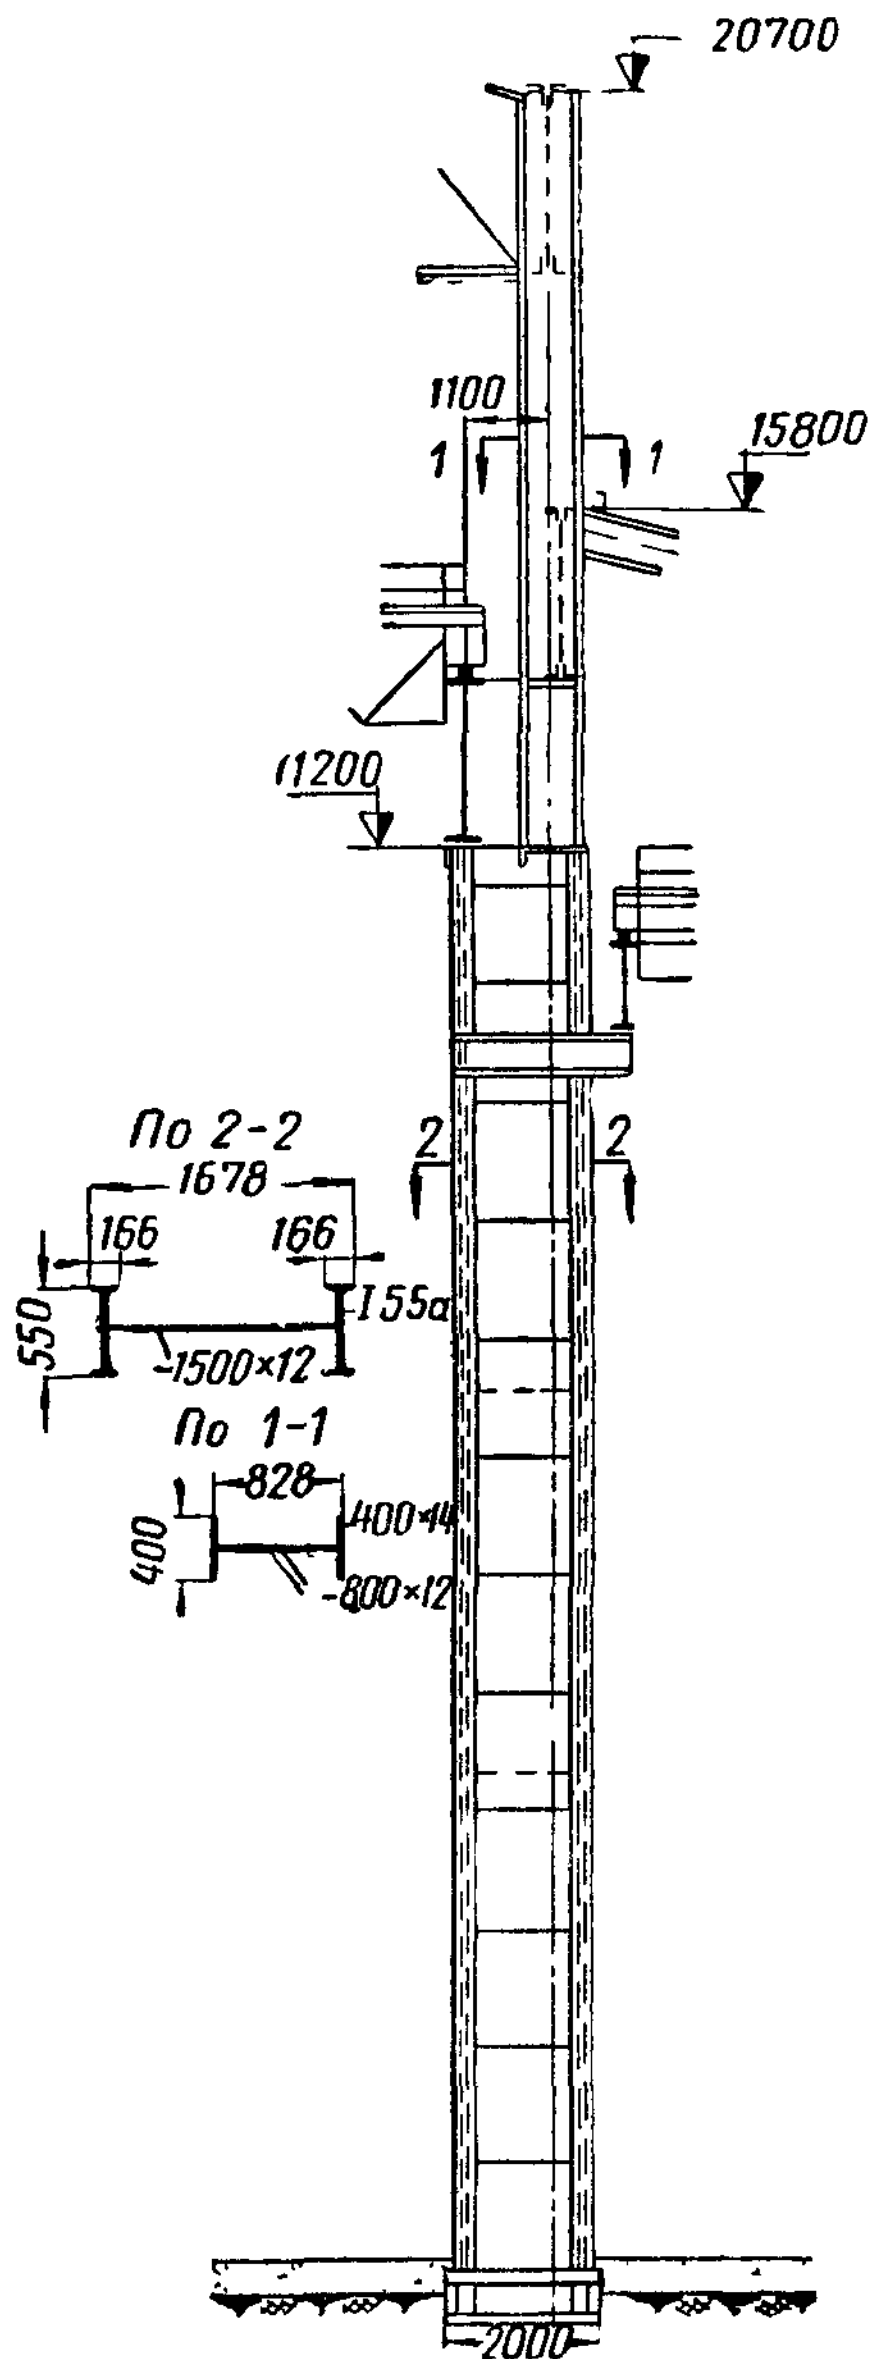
Пример опирания тяжелого крана на подкрановую площадку и легкого крана на консоль
